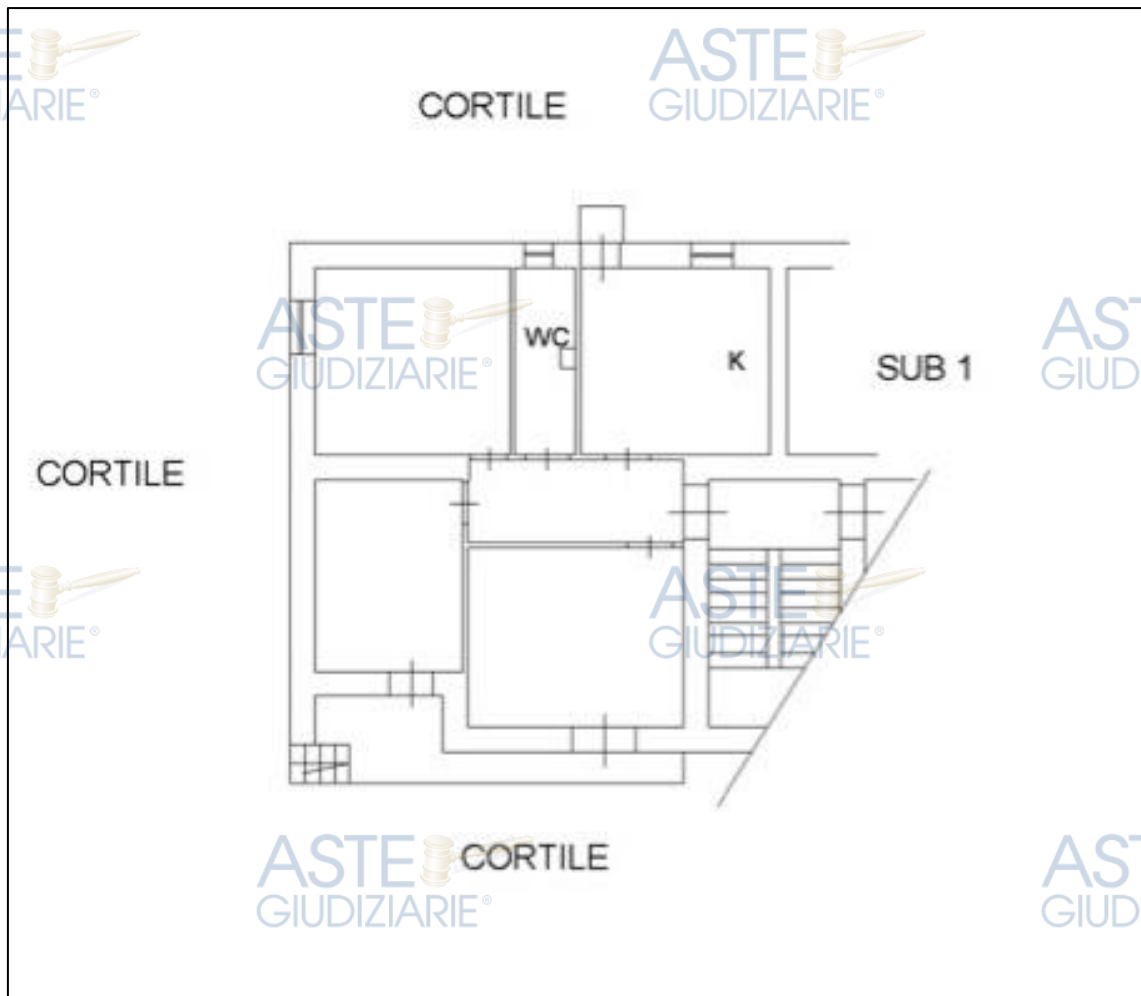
Planimetria agli atti del C.F. dal 15/10/2014.
